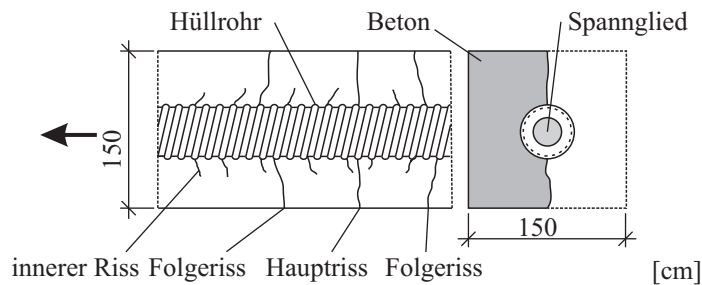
Rissbildung im Bereich der Hüllrohroberfläche nach THORMÄHLEN [115]
